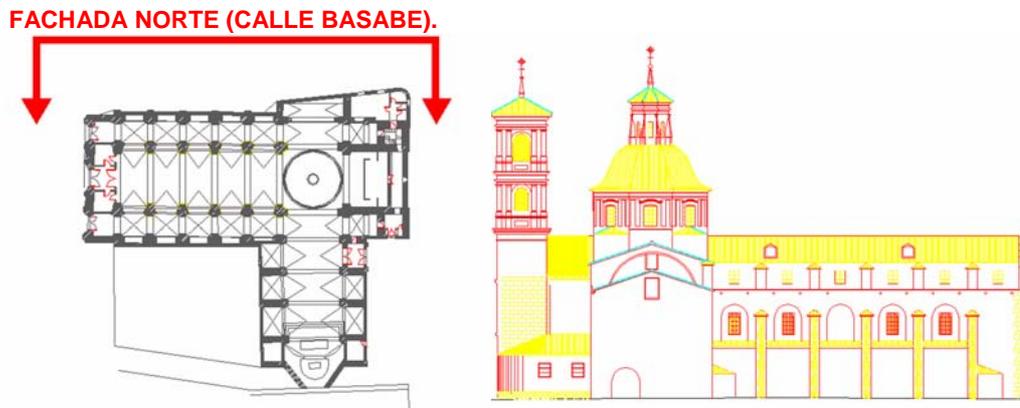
Ubicación en planta de la fachada norte de la iglesia situada en la calle Basabe (izquierda) y el exterior de la fachada (derecha).
